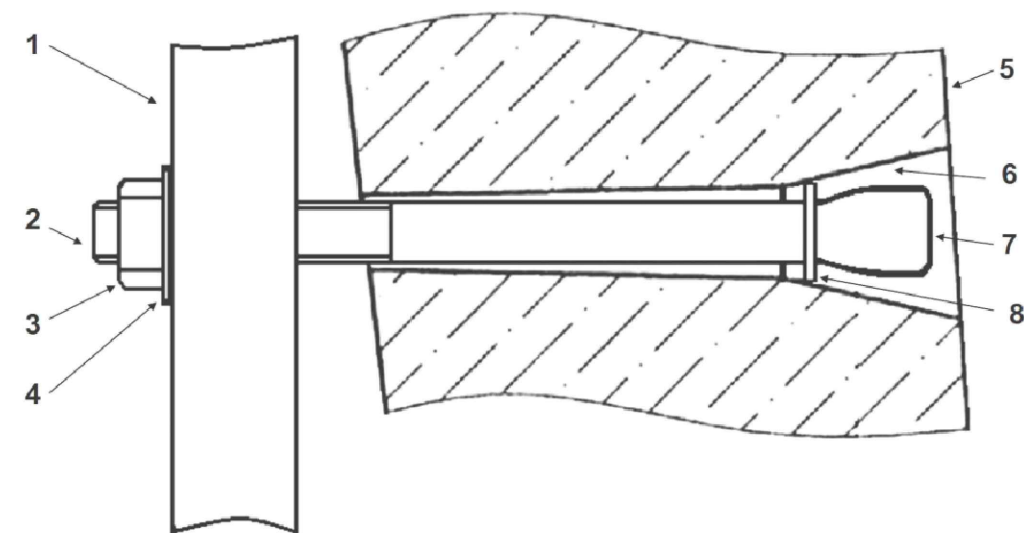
Крепление кронштейна типа ККП с помощью ершей с резьбой: 1 – кронштейн ККП; 2 – ёрш, конец с резьбой М12; 3 – гайка М12; 4 – шайба; 5 – боковая стена колодца; 6 – отверстие для ерша; 7 – ёрш, расплющенный конец; 8 – шайба.
